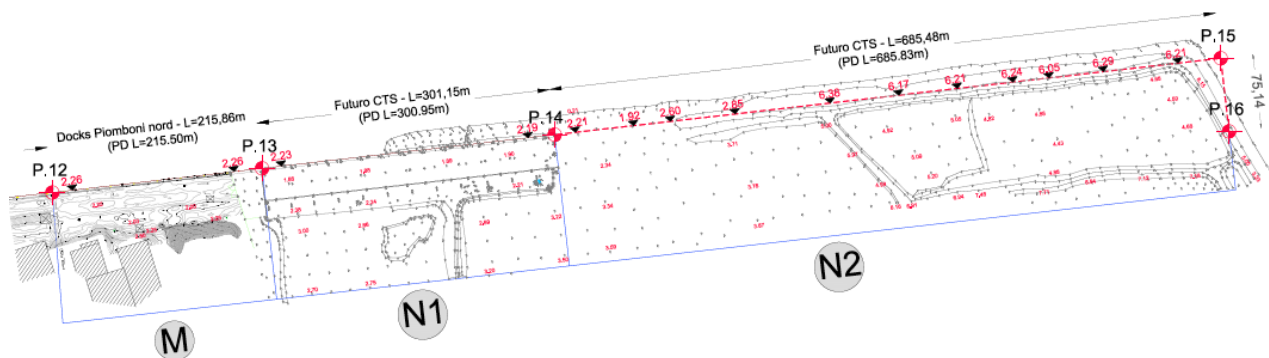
Stralcio 3 Planimetria inquadramento banchine
